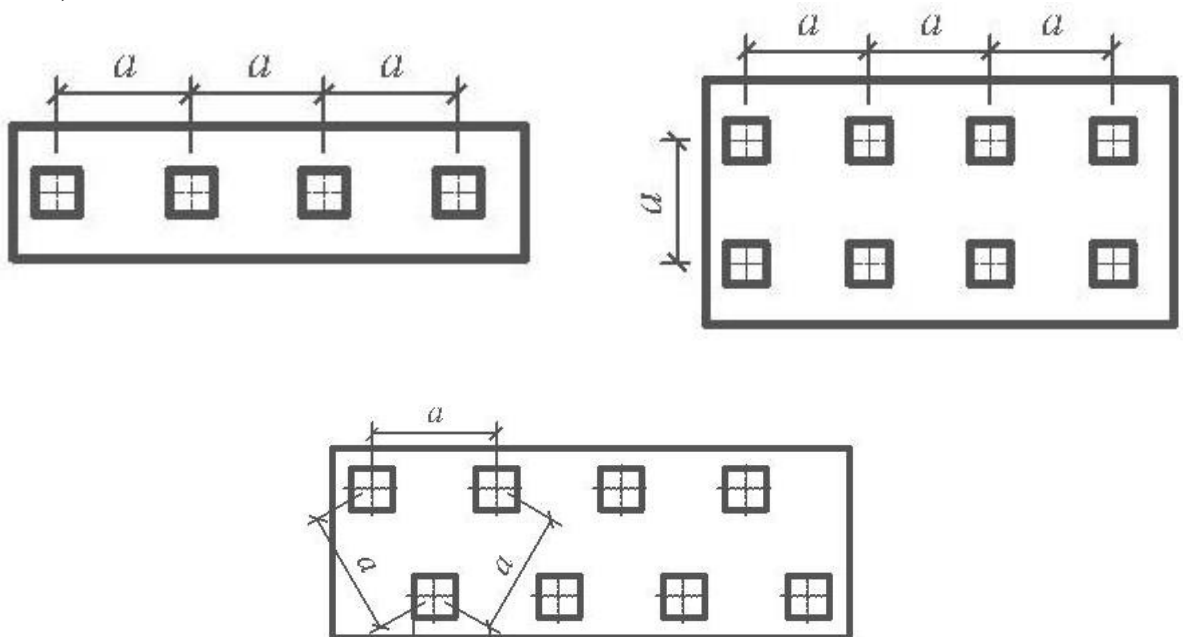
Пример расположения свай в фундаменте под колонны (а) и стены (б).
